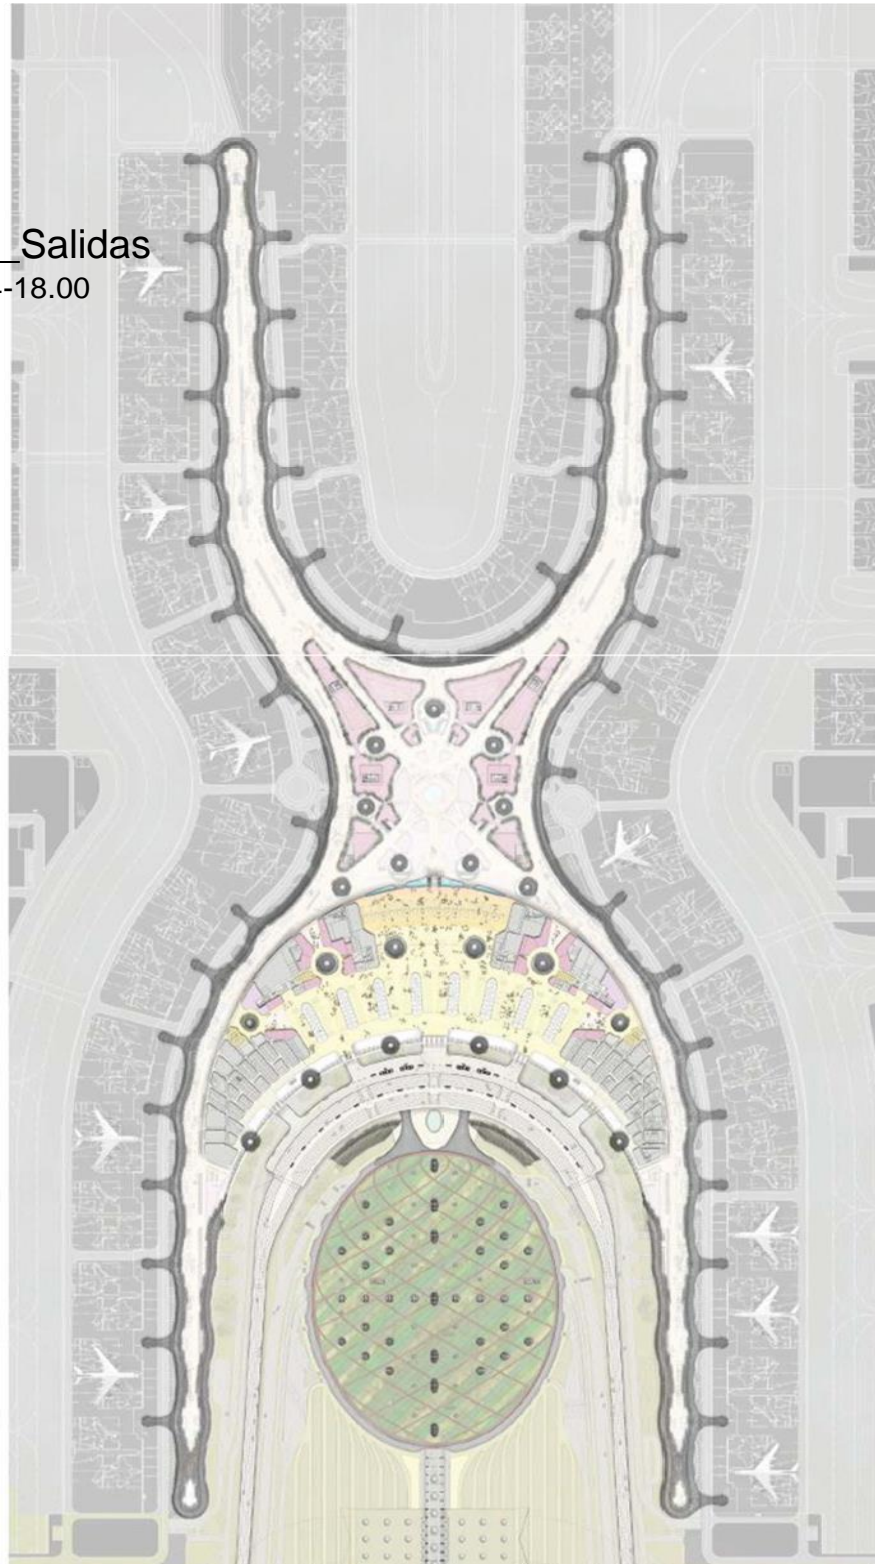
Plantas de la Disposición General de Distribución del Edificio Nivel 4
